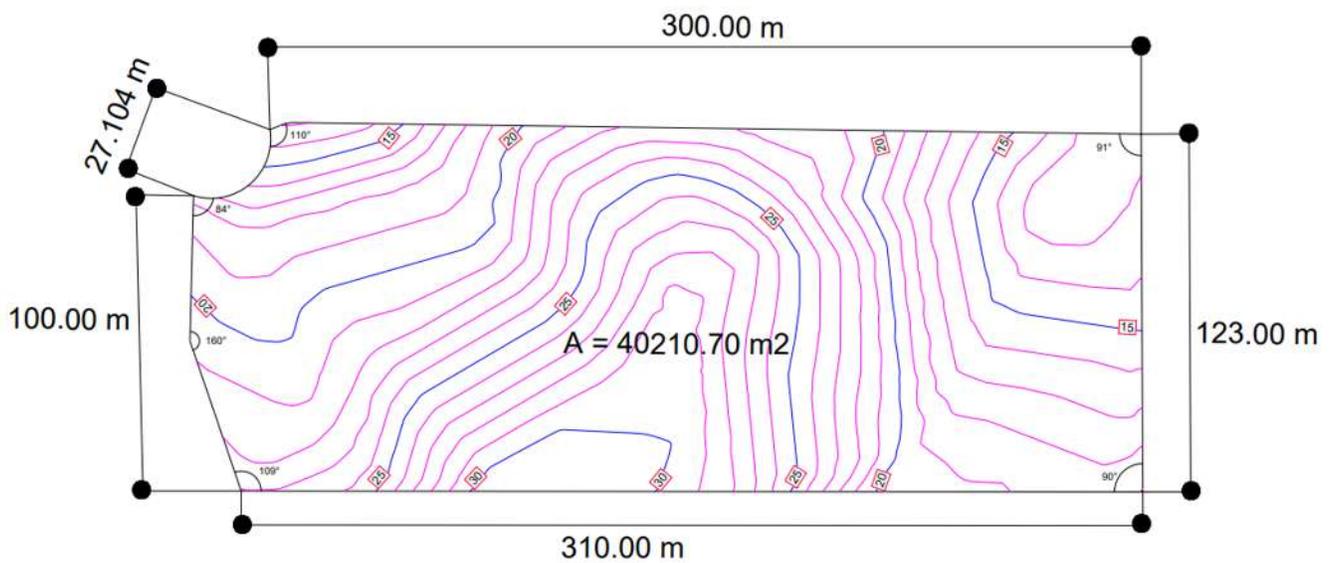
Plano del terreno con niveles, medidas del terreno sugerido
